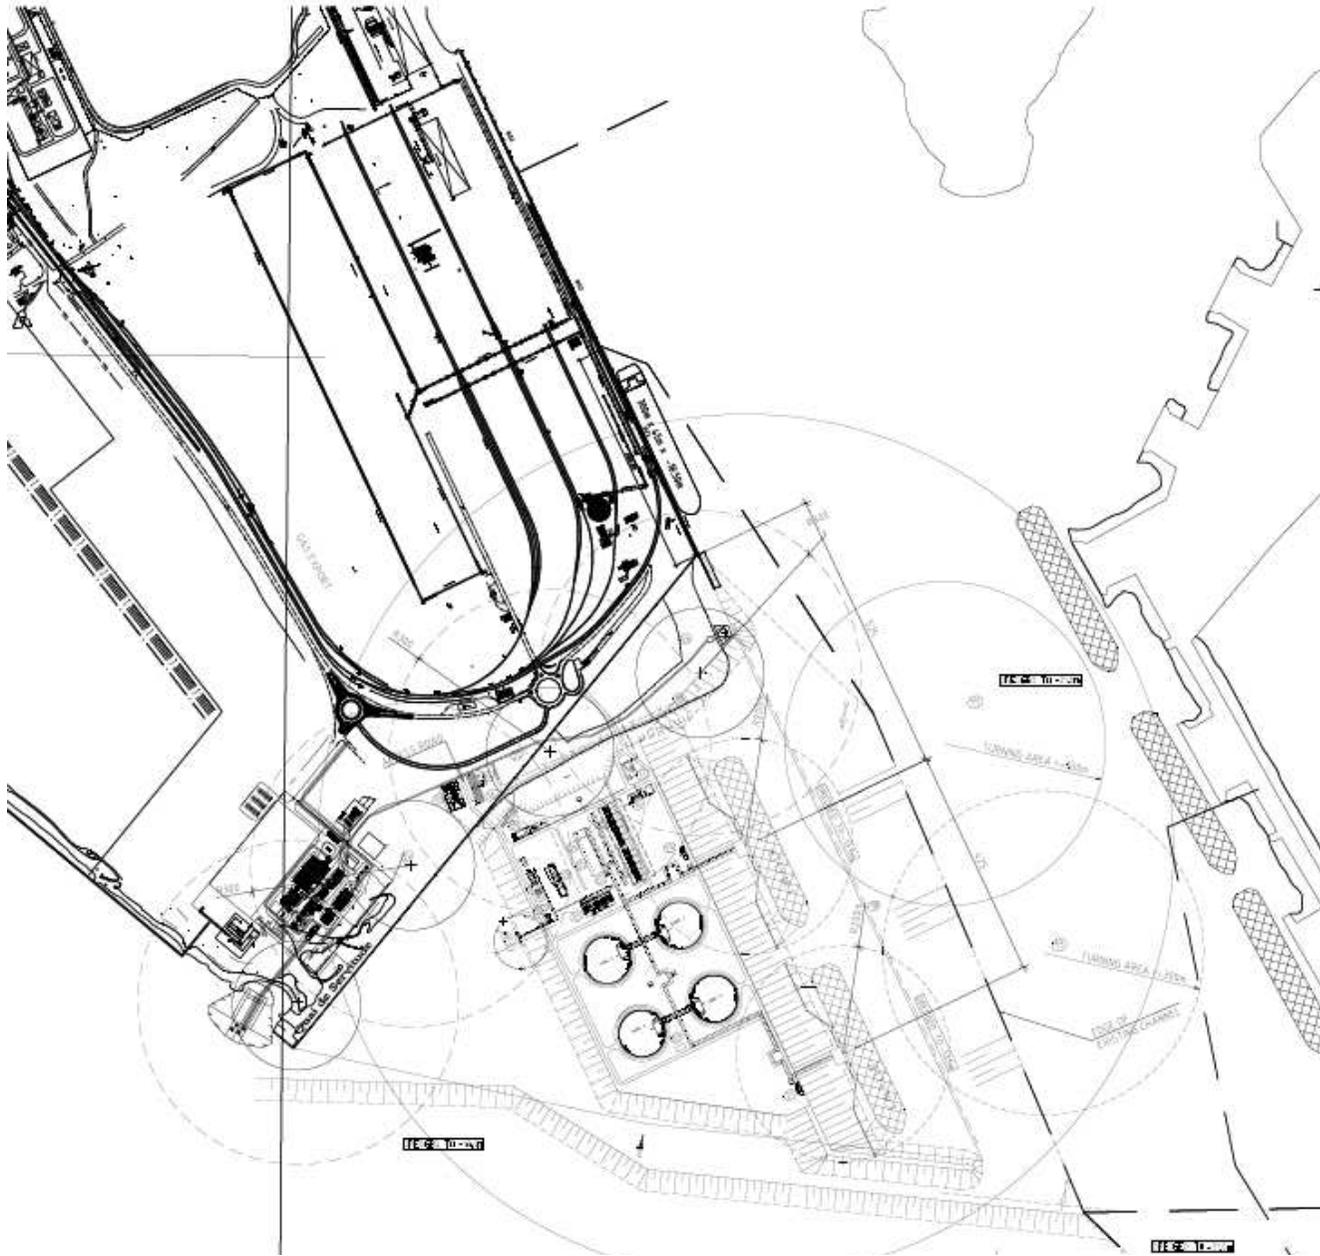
Plan d'implantation du projet Fos Faster dans la ZIP : zone Caban Sud
